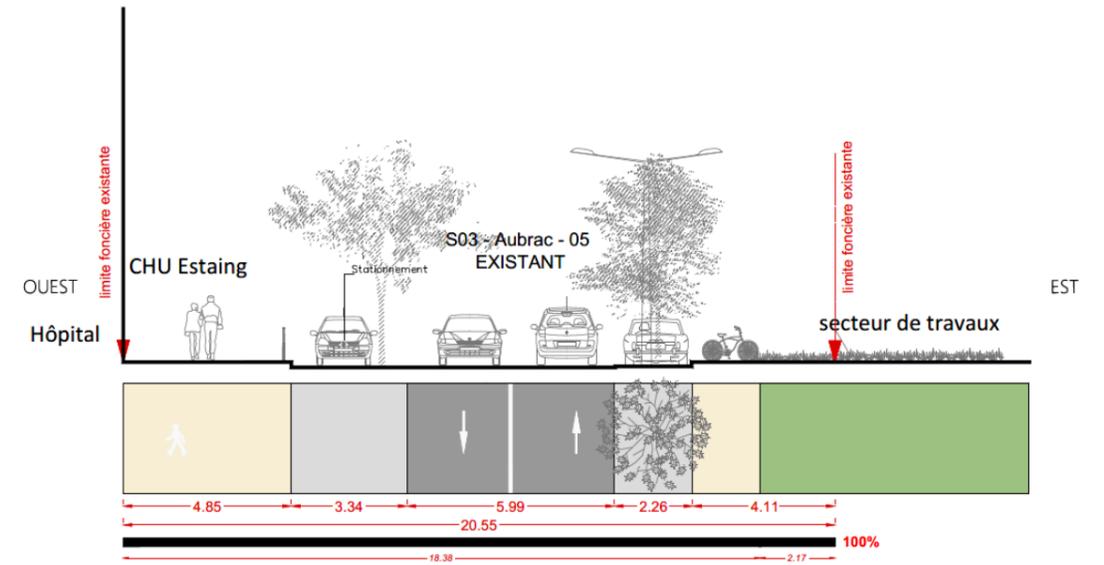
Profil existant sur la rue Aubrac au droit du CHU Estaing
